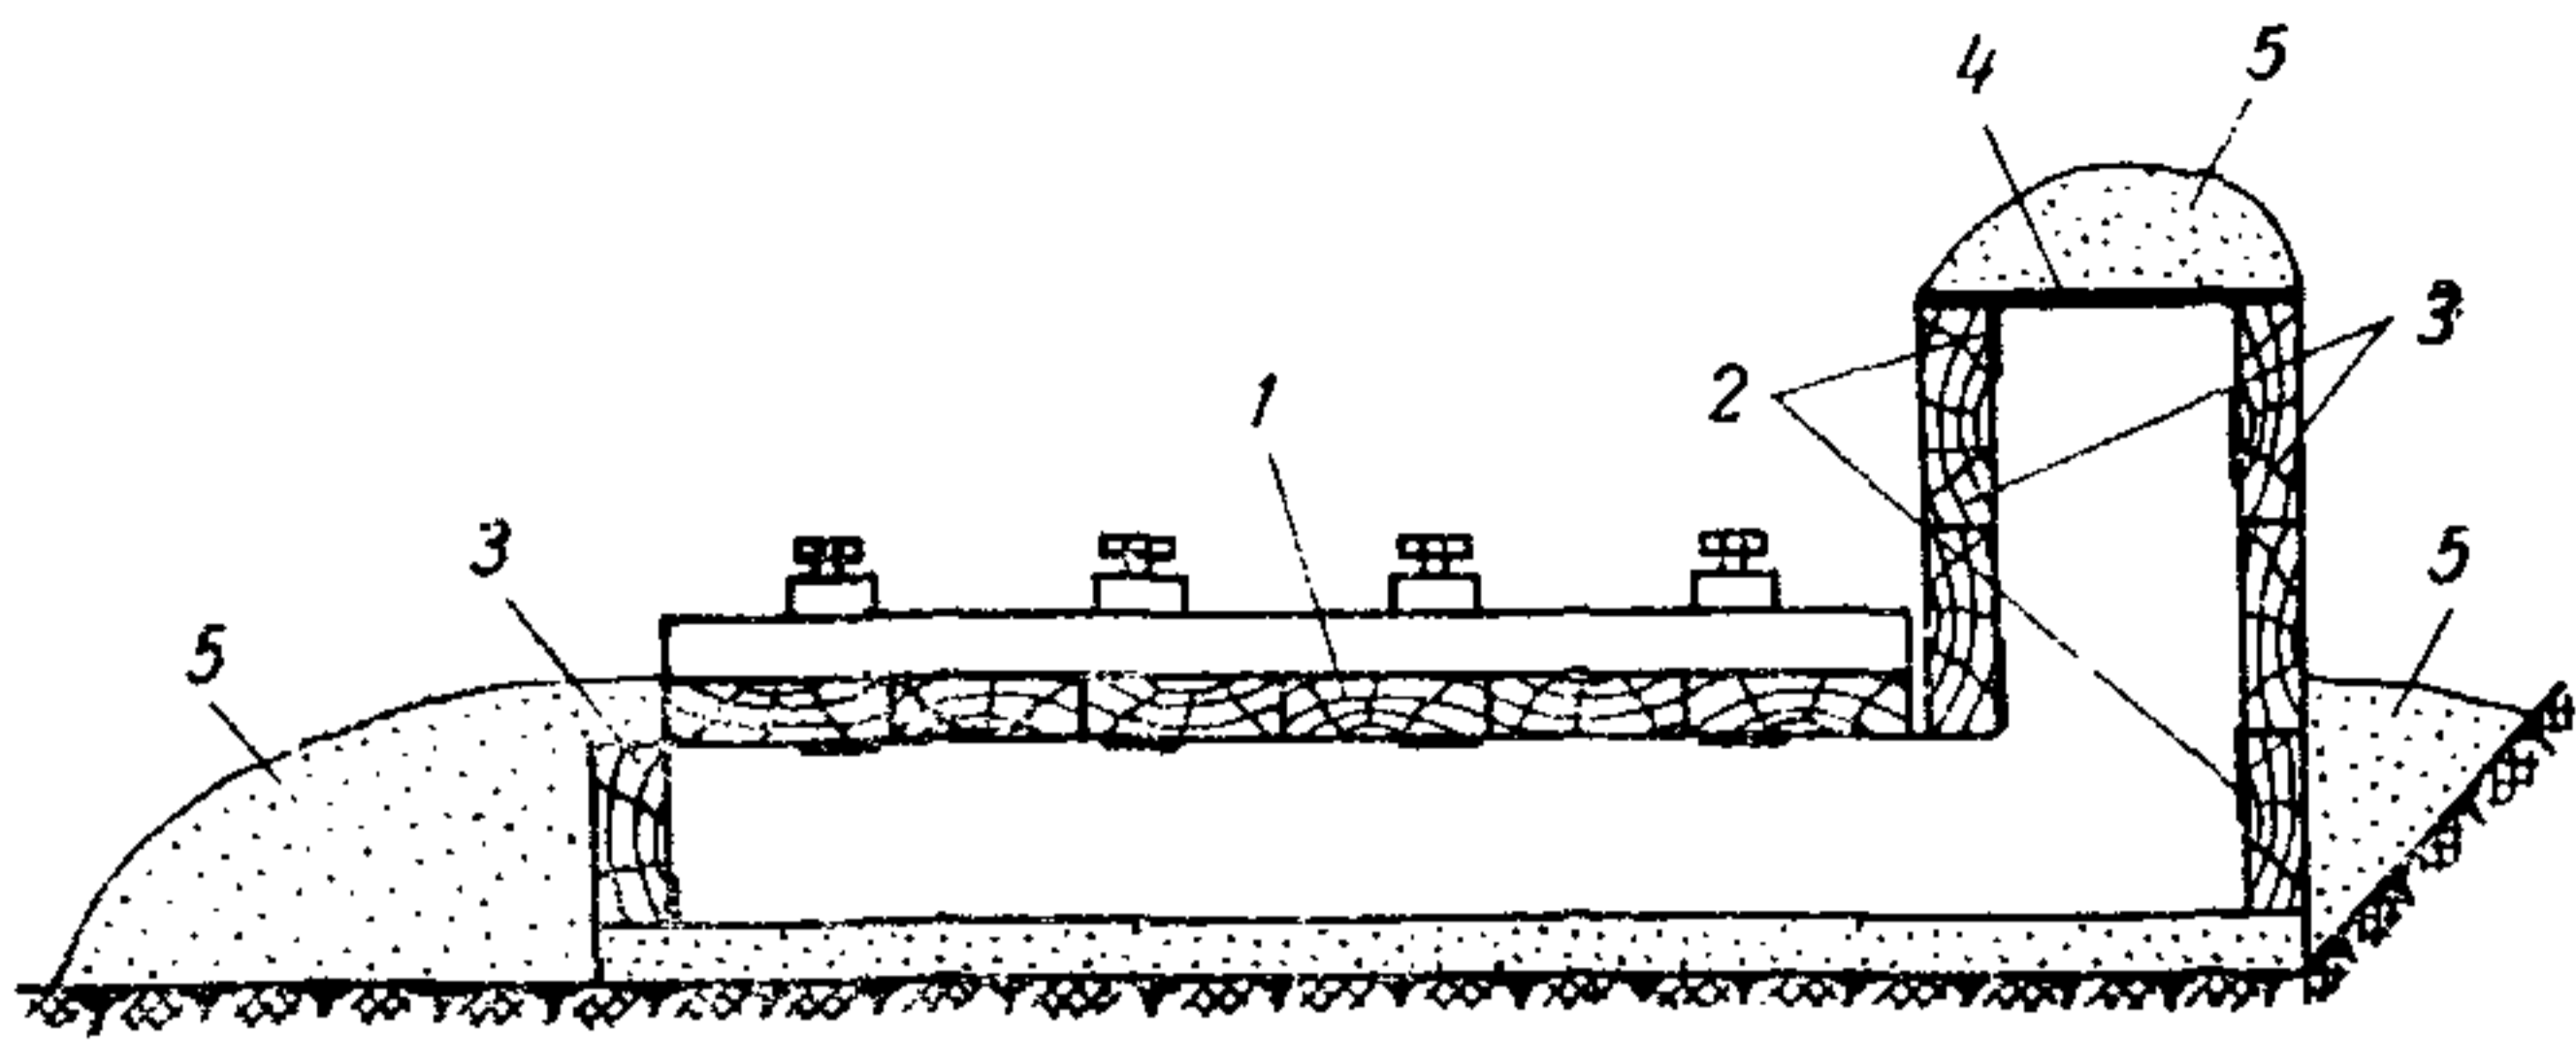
Схема размещения электродов при электропрогреве бетона кольцевого фундамента
